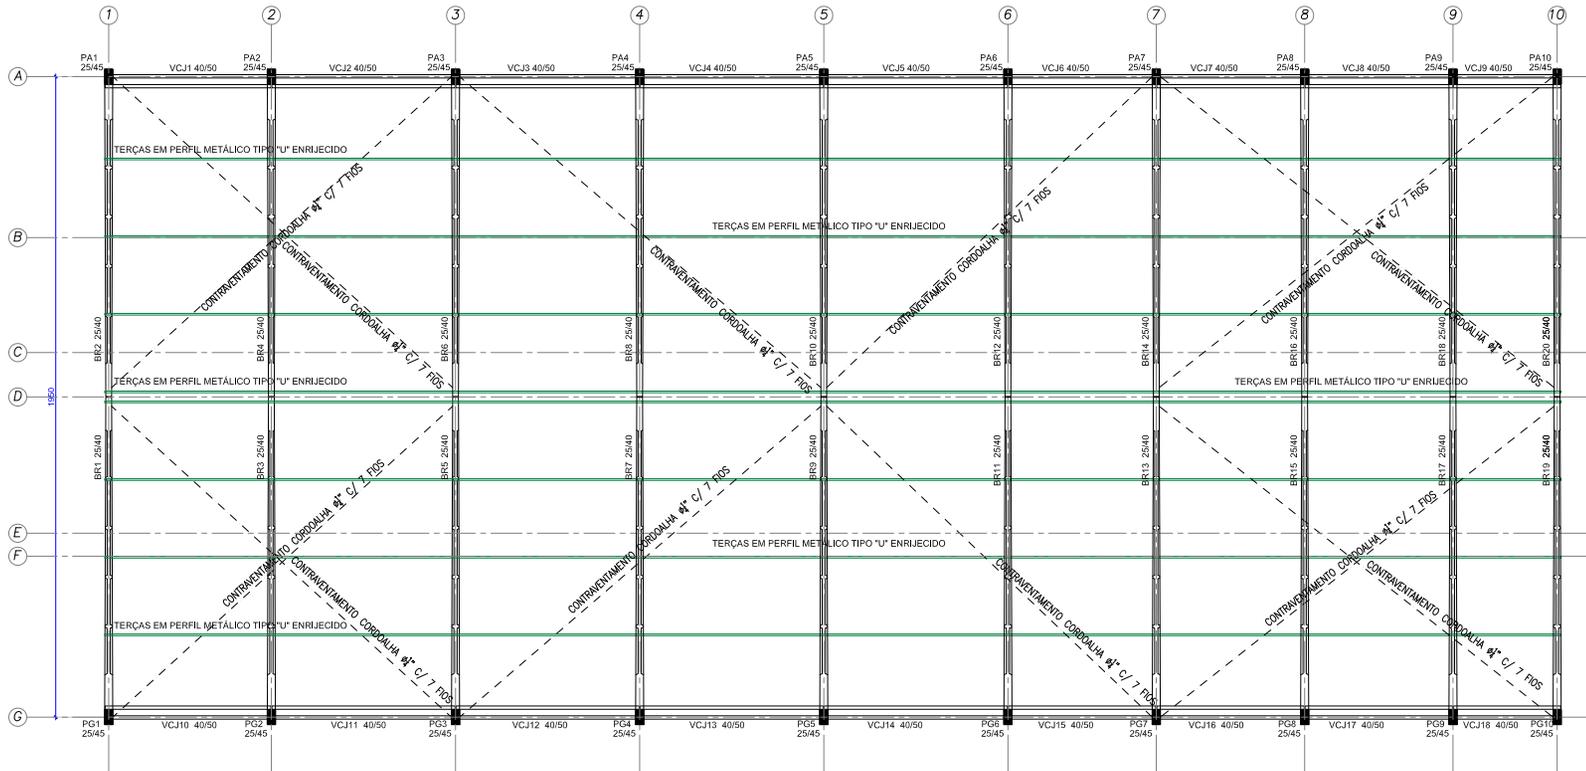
Planta de fôrmas/montagem nível cobertura da obra do caso B
